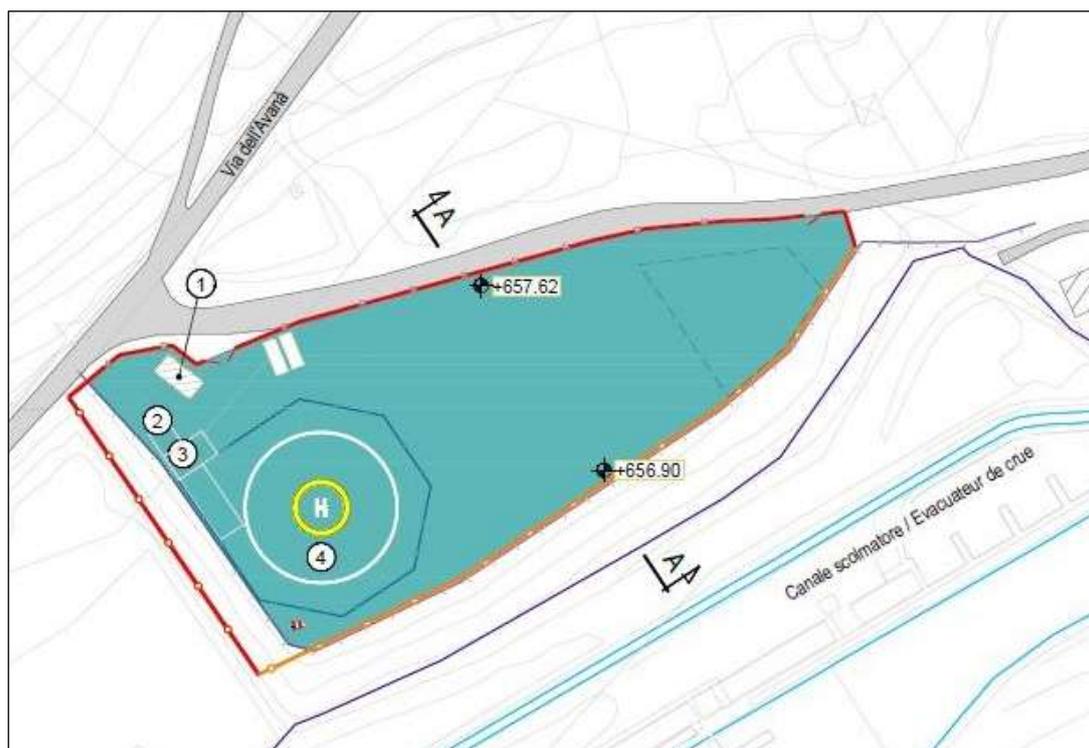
Planimetria area di cantiere con le opere incluse nel PE di 1a fase
